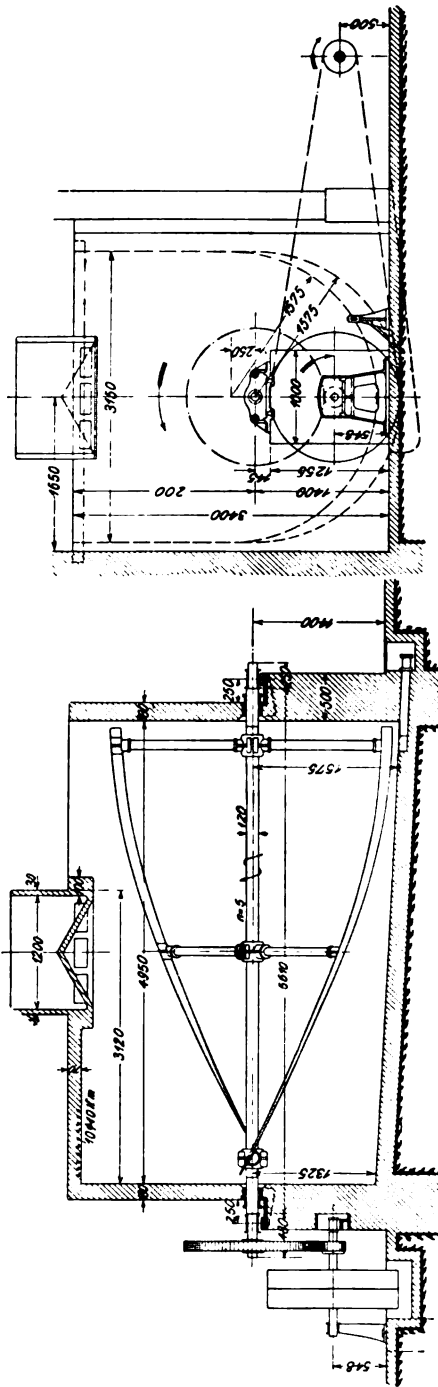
Rührbütteln von 45 m³ in Eisenbeton. Klein-Neusiedel.
